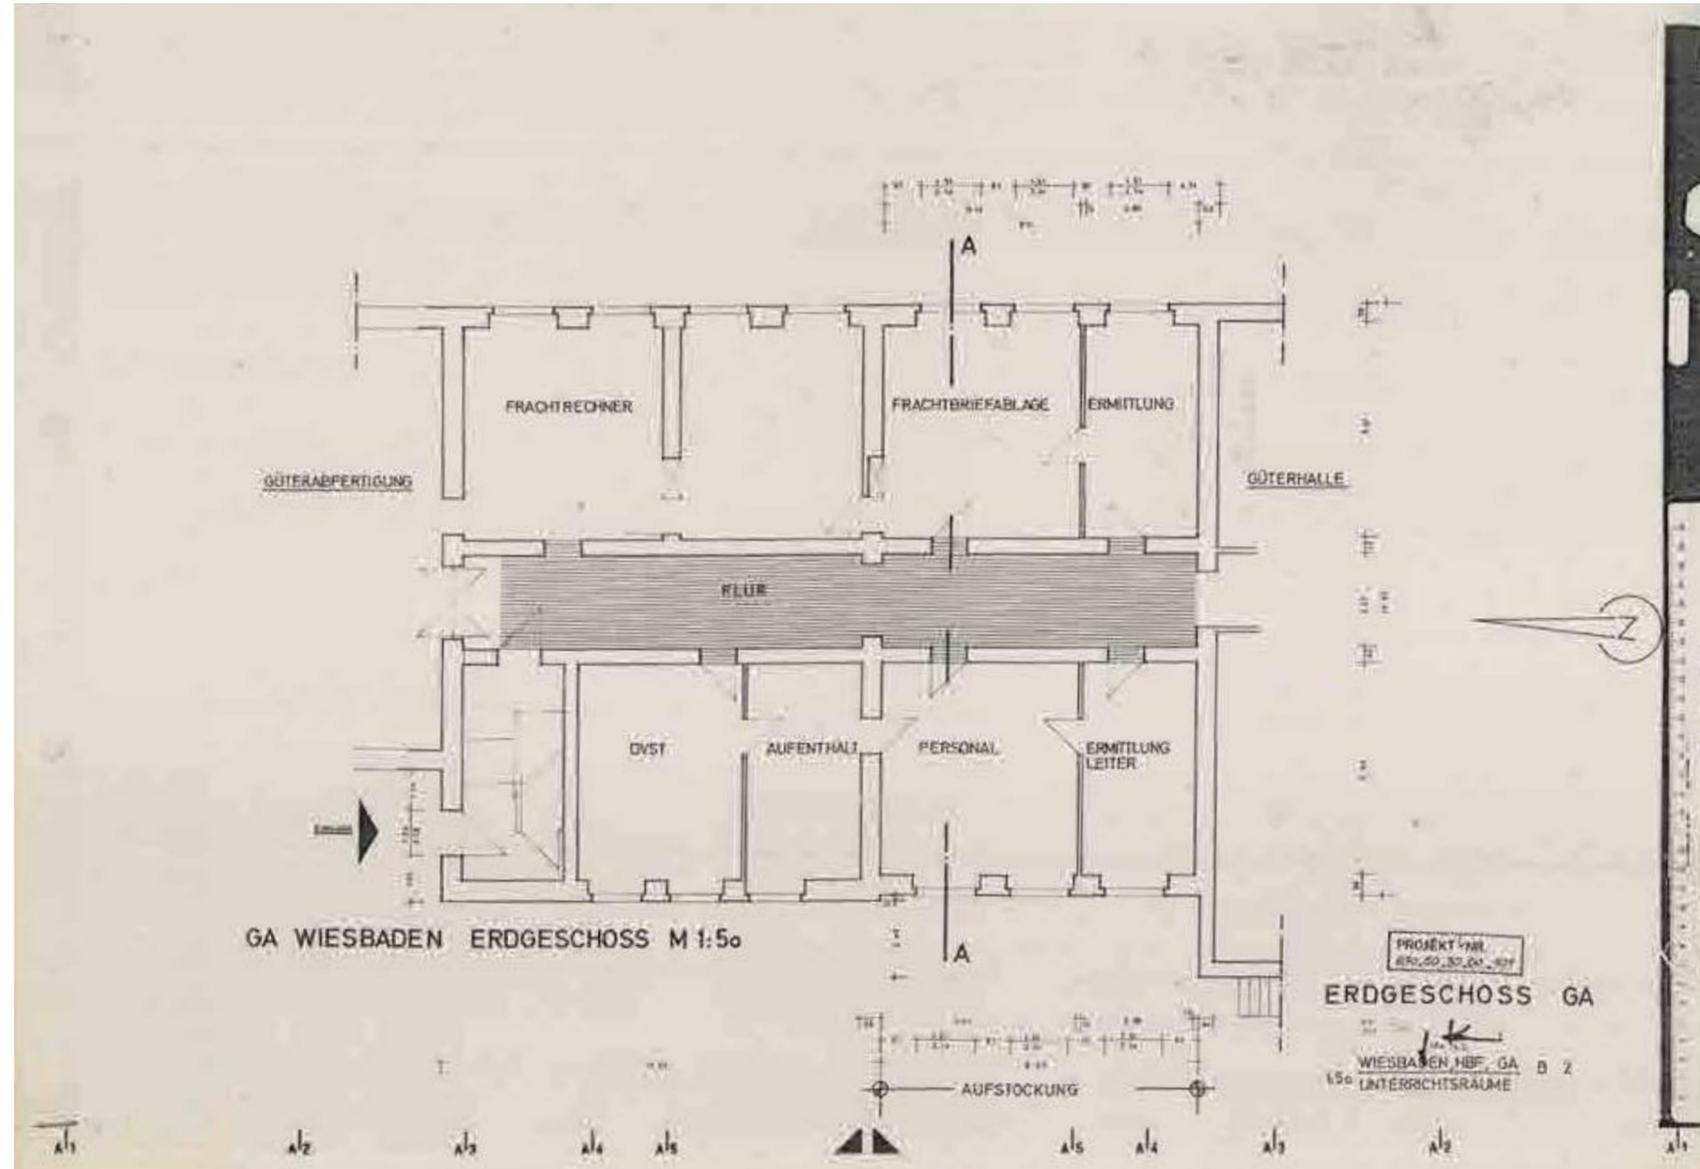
Güterabfertigung: Plan mit Grundriss des Erdgeschosses am Südende der Güterabfertigung, 1975
